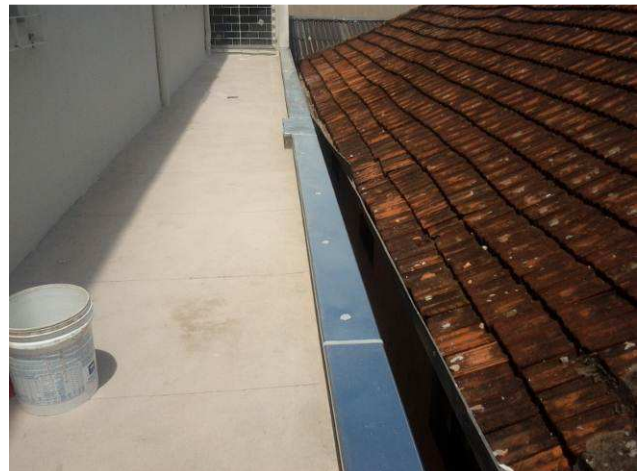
C: Rufo instalado na mureta do corredor lateral direito do primeiro pavimento
